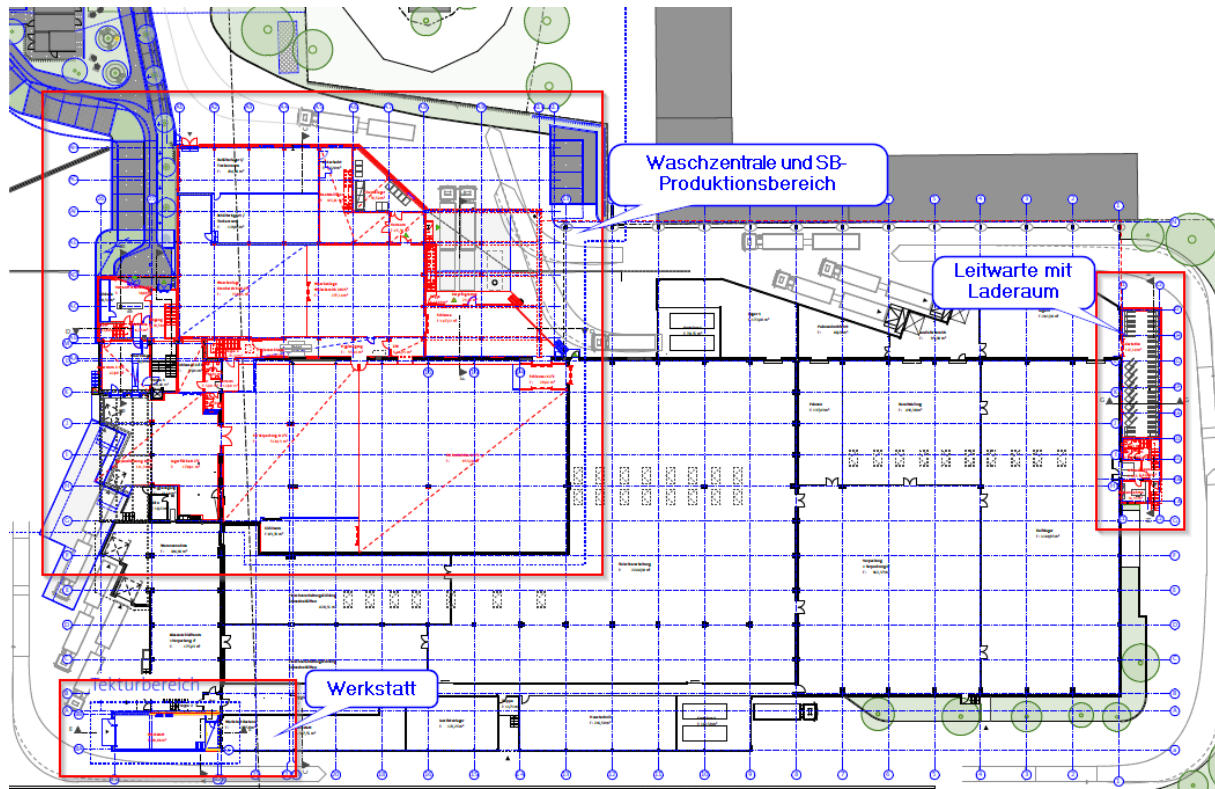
Gebäudegrundriss der BayernFleisch GmbH nach Umbau 2020/2021, Planstand 21.06.2021. Die neuen Gebäudeteile sind mit roten Kästen markiert.
